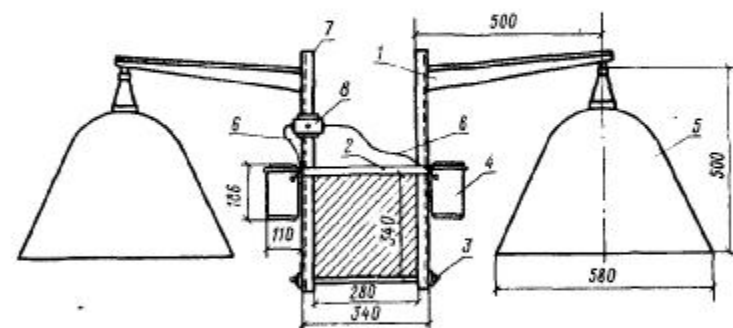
Блок из двух светильников с лампой ДРЛ с креплением на железобетонной ферме
